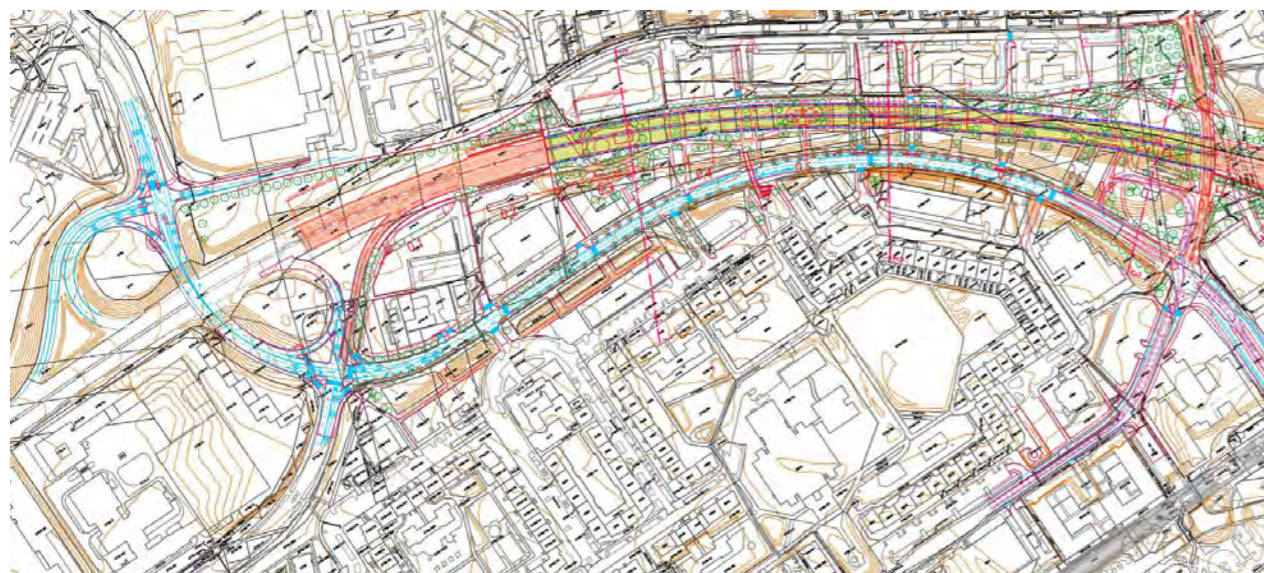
Oblast MÚK Řeporyjská dopravní situace varianta A
